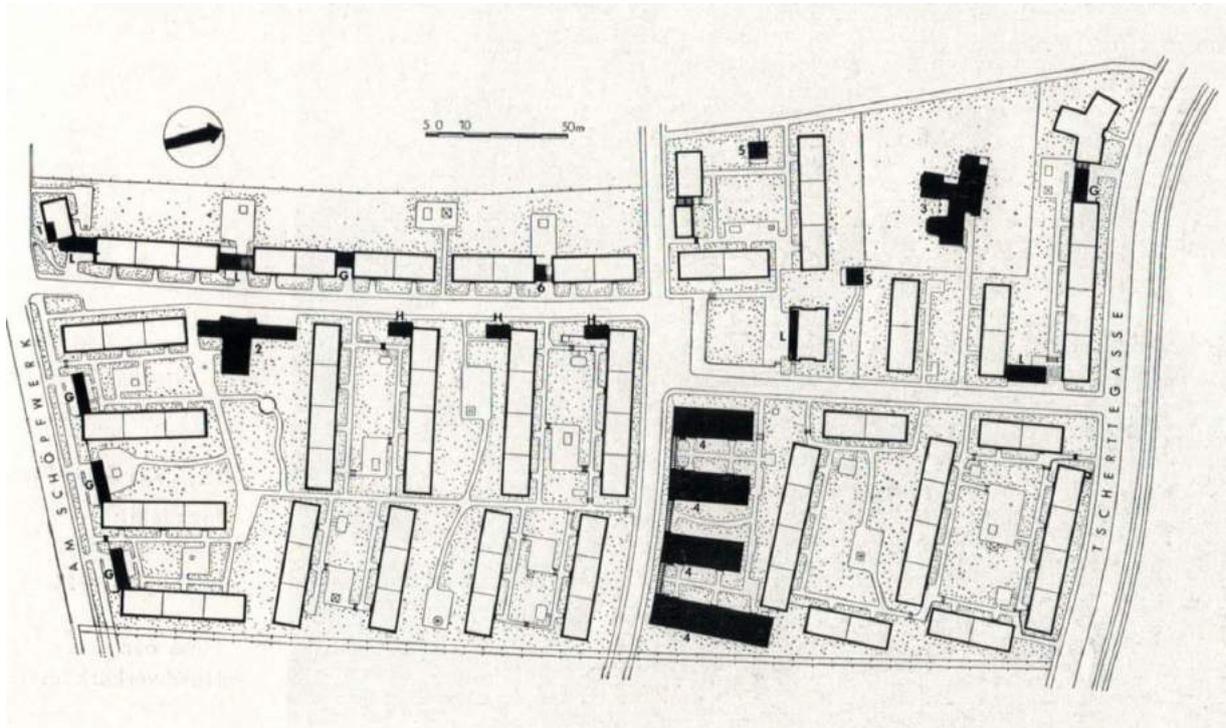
Lageplan Siedlung „Am Schöpfwerk“
